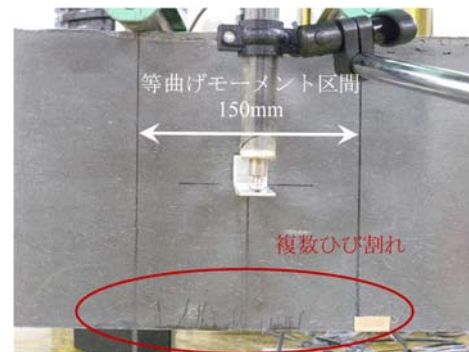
ひび割れ発生状況(A方向載荷 最大荷重時)
